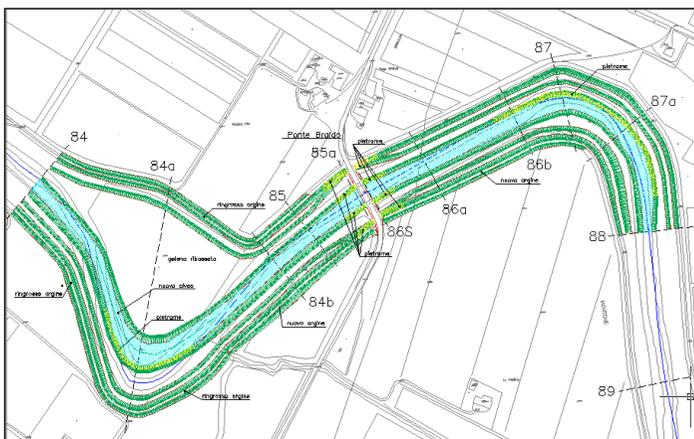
Planimetria di progetto del III lotto sul fiume Montone
